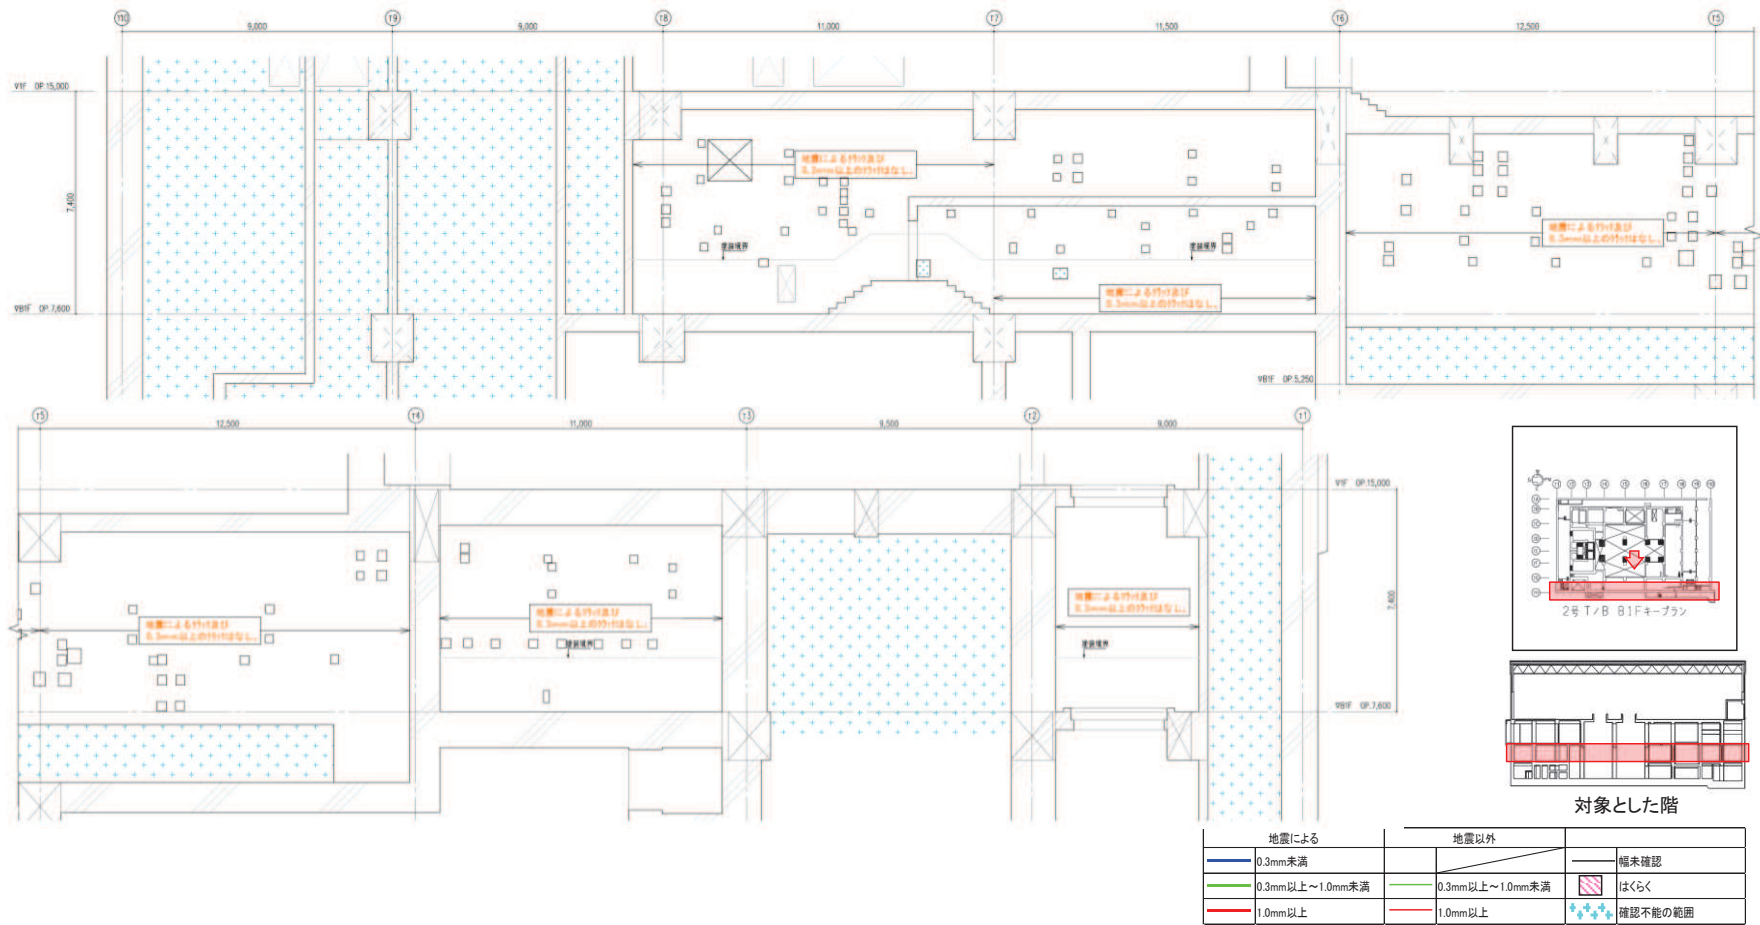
タービン建屋のひび割れ分布 耐震壁 (32) 地下1階 TH 通り
